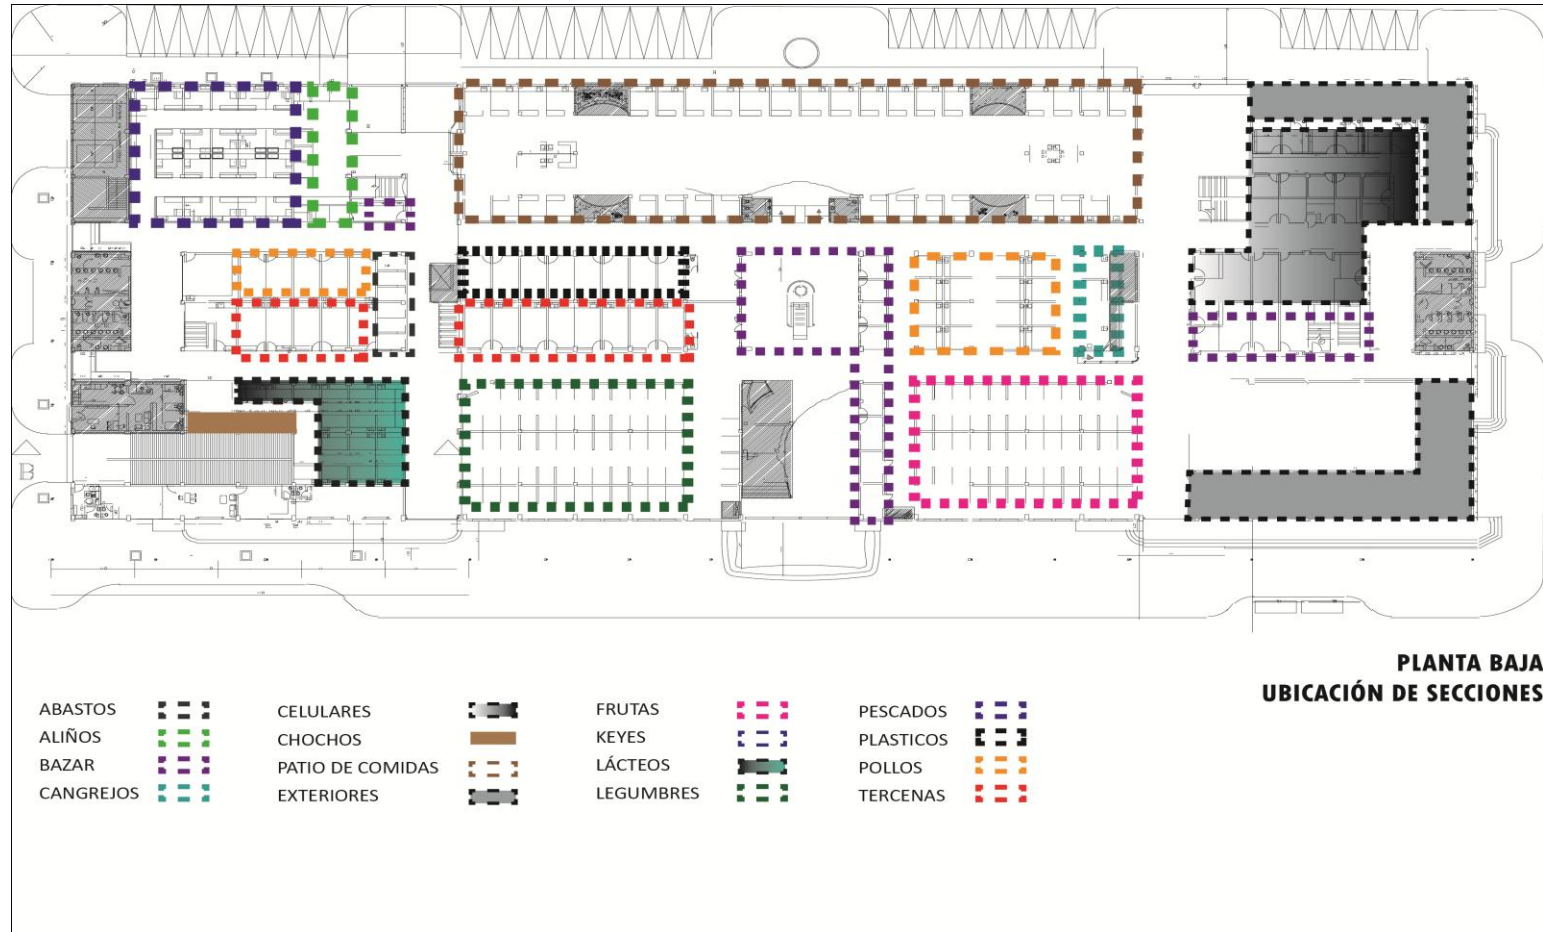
Secciones planta baja Centro Comercial Popular “La Condamine”
